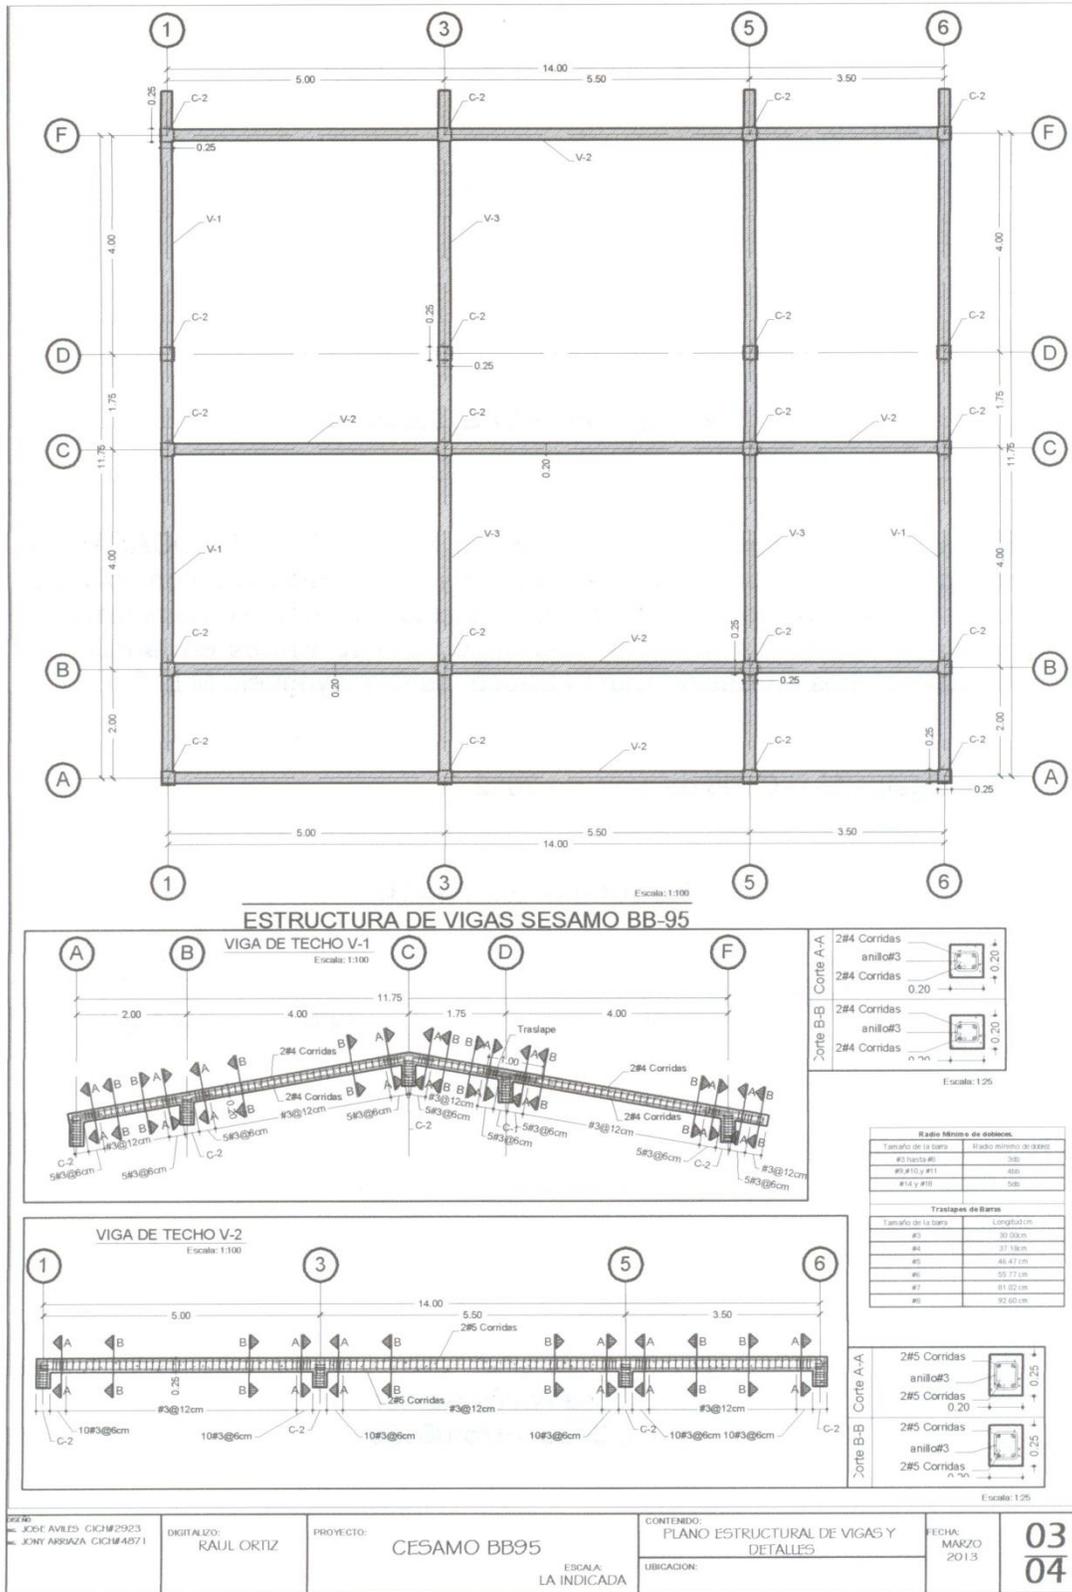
Plano Estructural de Techo CESAMO Tipo I Nivel 12X14m
